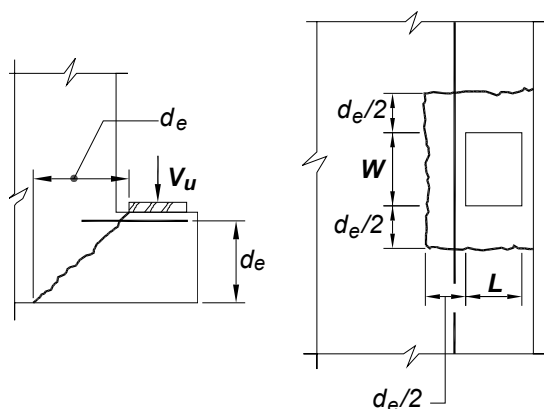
Diseño de los resaltes horizontales al punzonado
